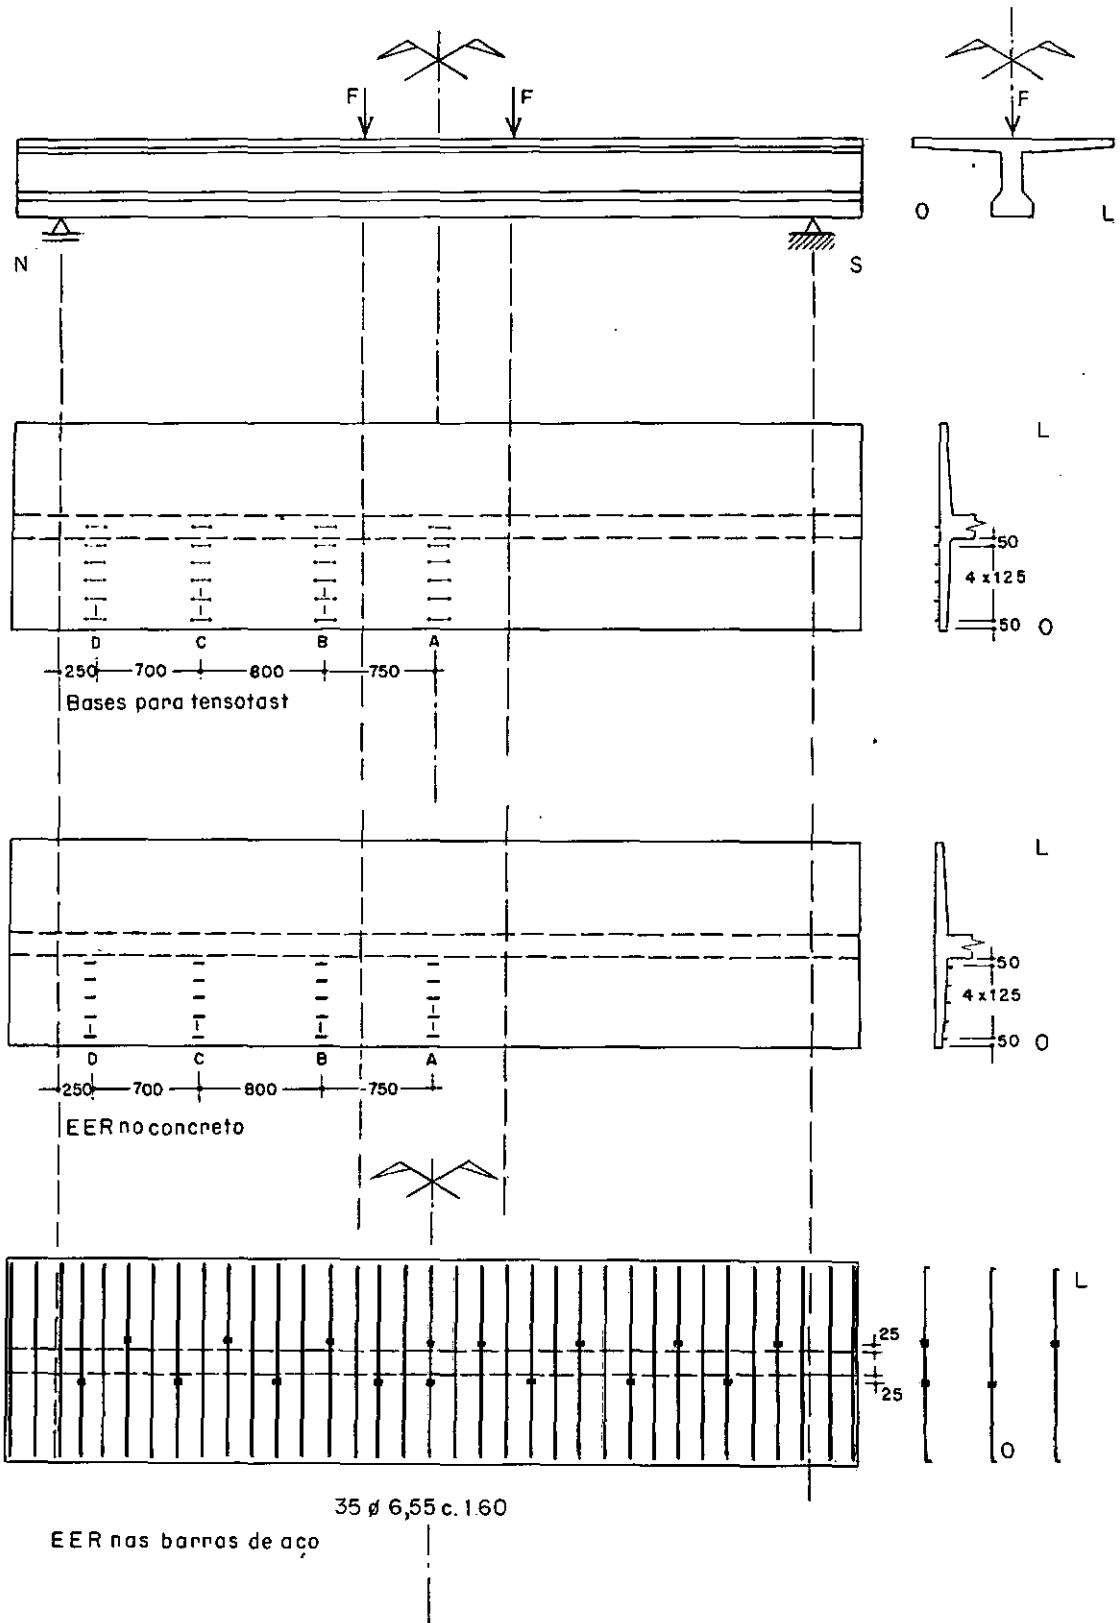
b - Instrumentação da viga T2 - (cotas em mm)
